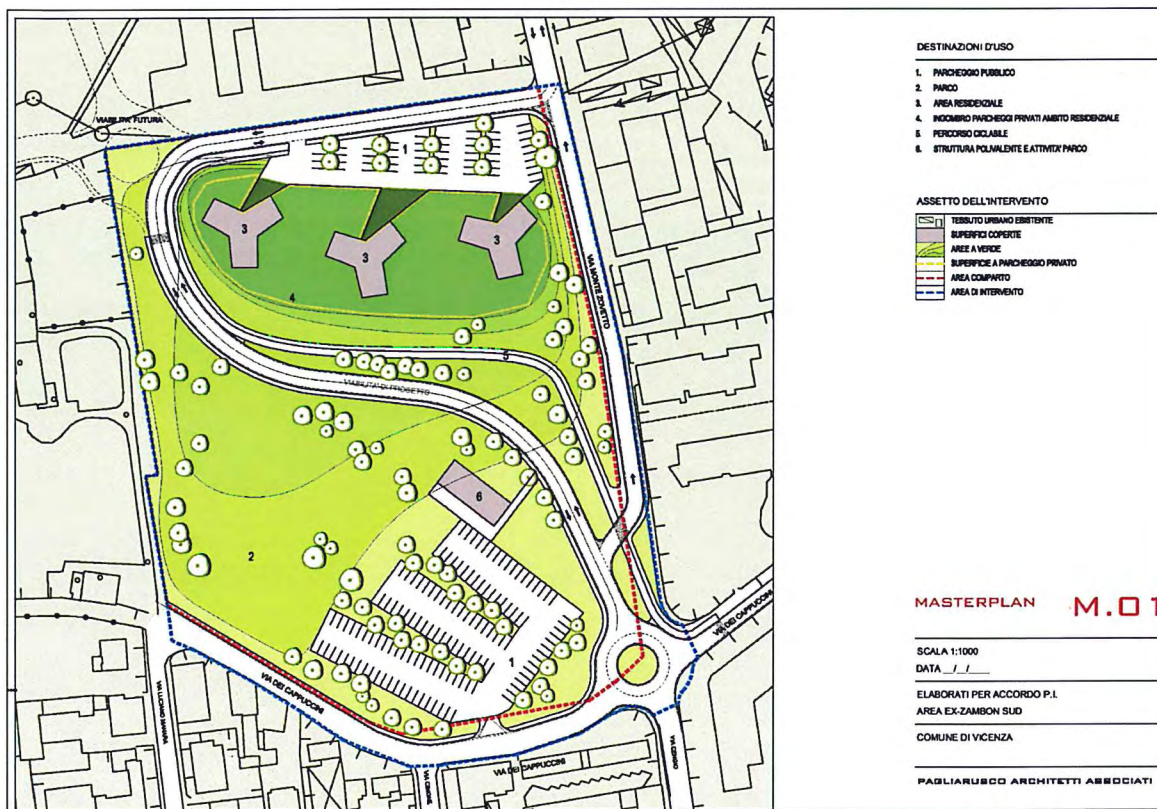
Planimetria del progetto di riqualificazione dell'area ex-Zambon Sud.
